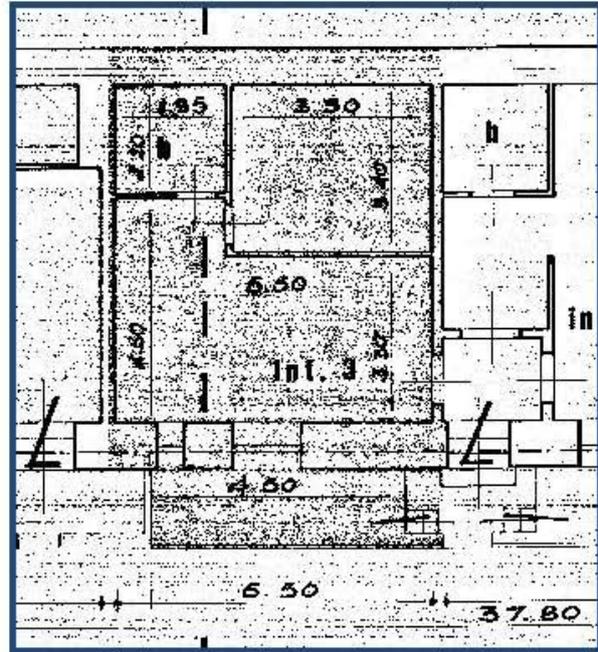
Stralcio Planimetria allegata all'istanza di Condono del 21/03/1986 prot. 94336 pratica n. 7968/1/86.
